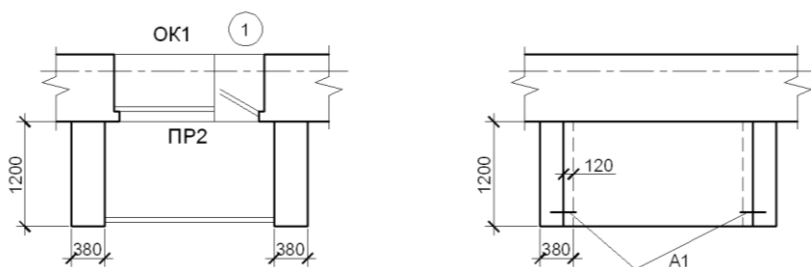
Изображение лоджии на плане этажа и плане перекрытия
